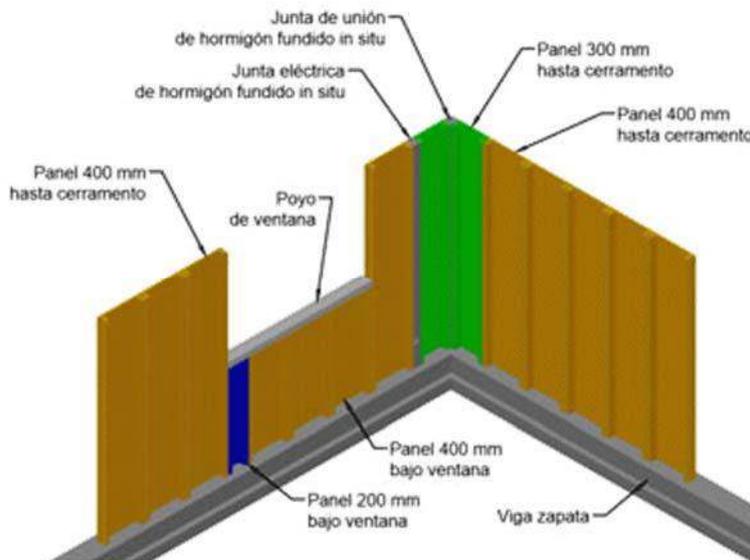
Ejemplo de montaje de elementos prefabricados de los muros.
